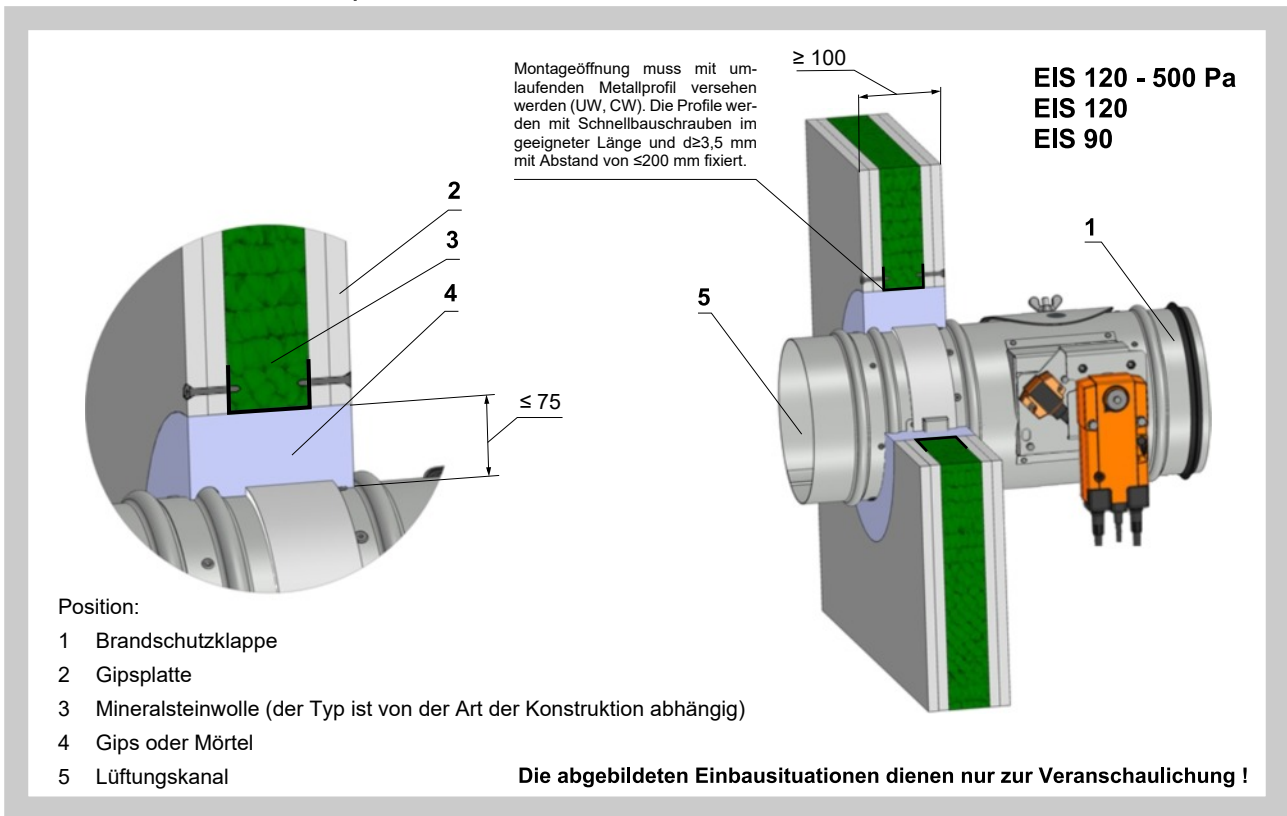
Leichtbauwand - Brandschutzdichtung mit Spachtelmasse und Anstrich
